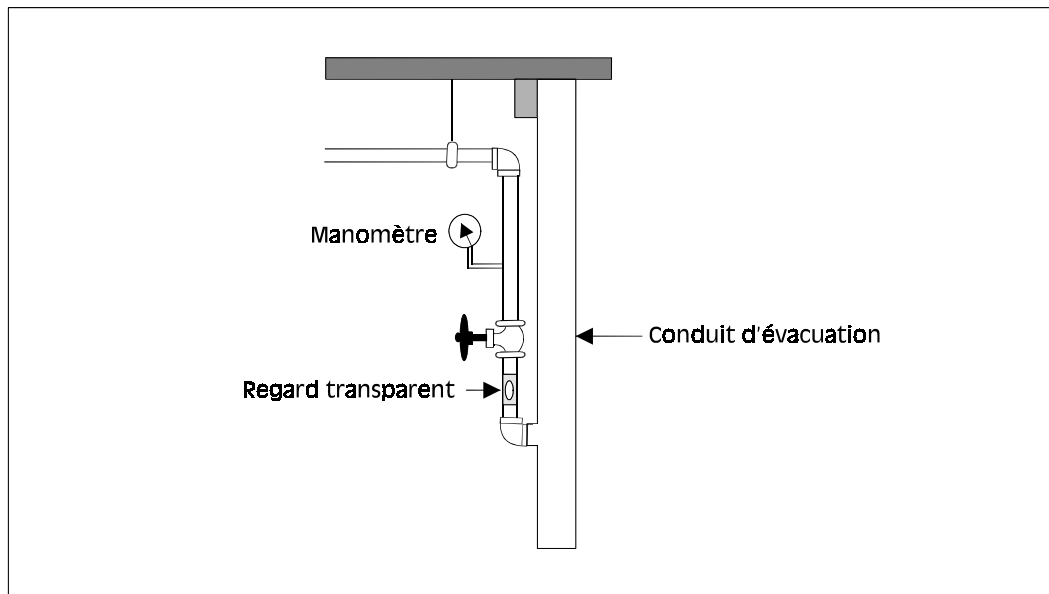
β : Dispositif d'essai point F avec rejet dans un conduit d'évacuation
